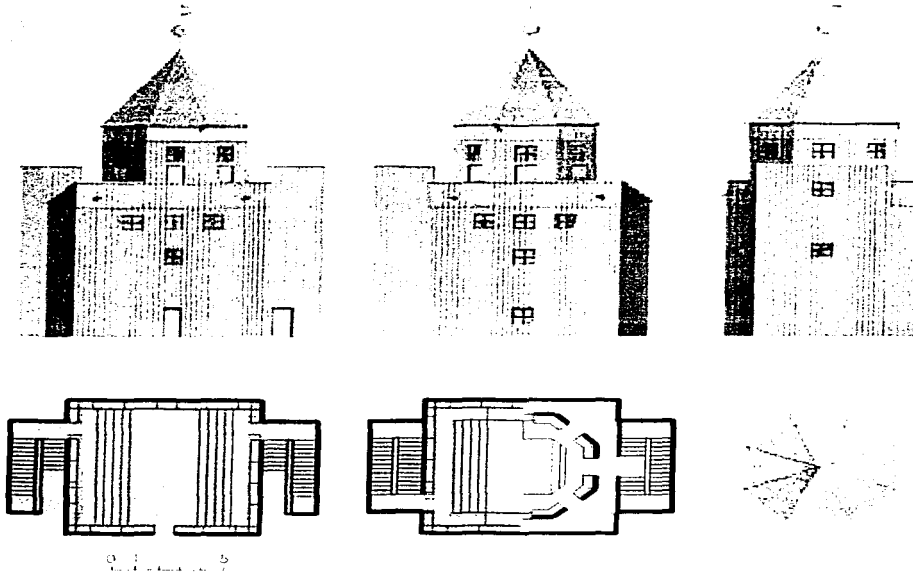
Plantas arquitectónicas y Fachadas de Teatro del Mondo.
